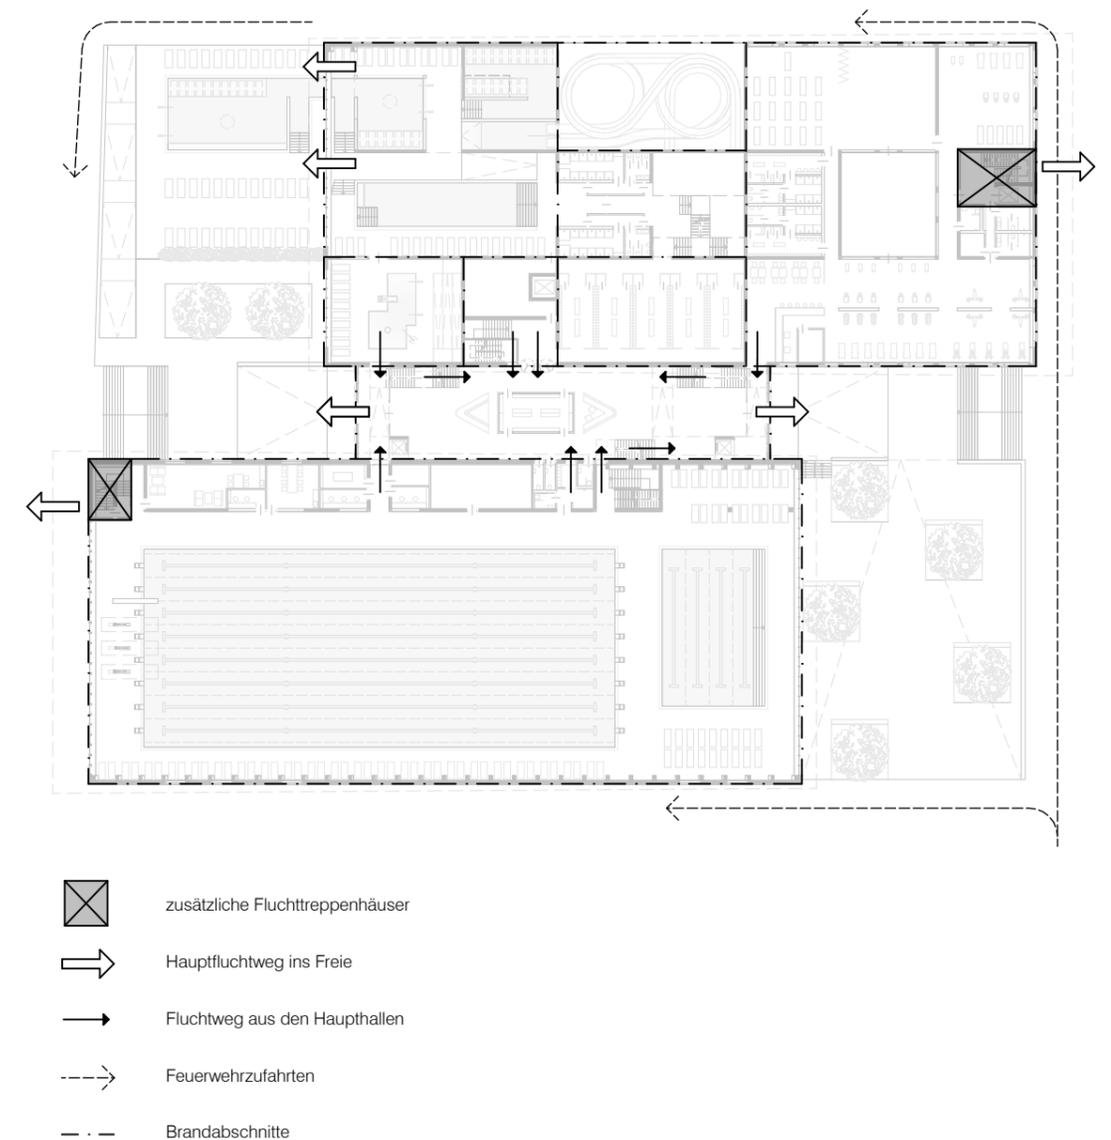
Grundriss 1.Obergeschoss 1:750
